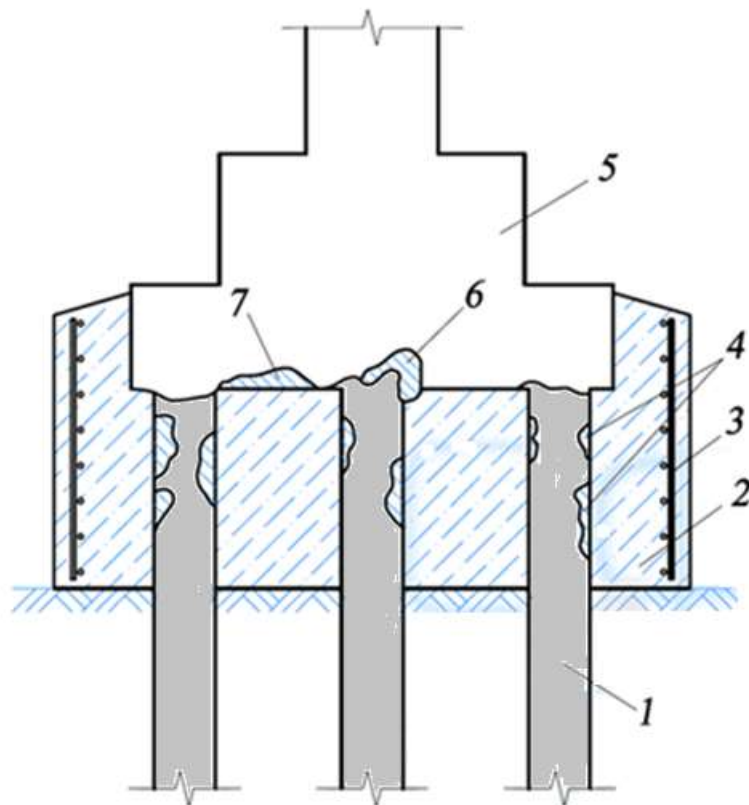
Схема підсилення верхніх кінців залізобетонних паль
